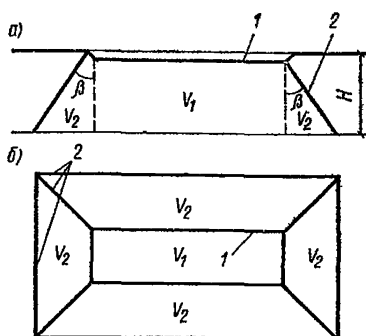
Поперечный разрез (а) и план (б) увлажненной зоны котлована
